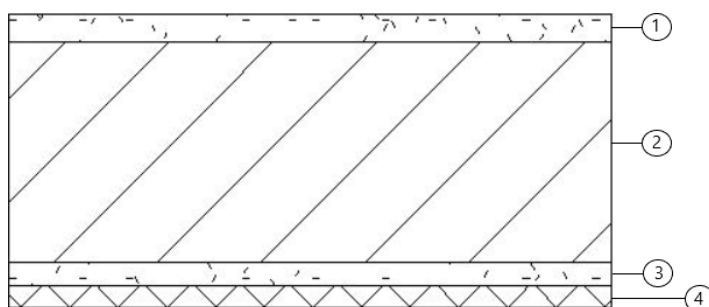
Pormenor da constituição da parede externa tipo E2
